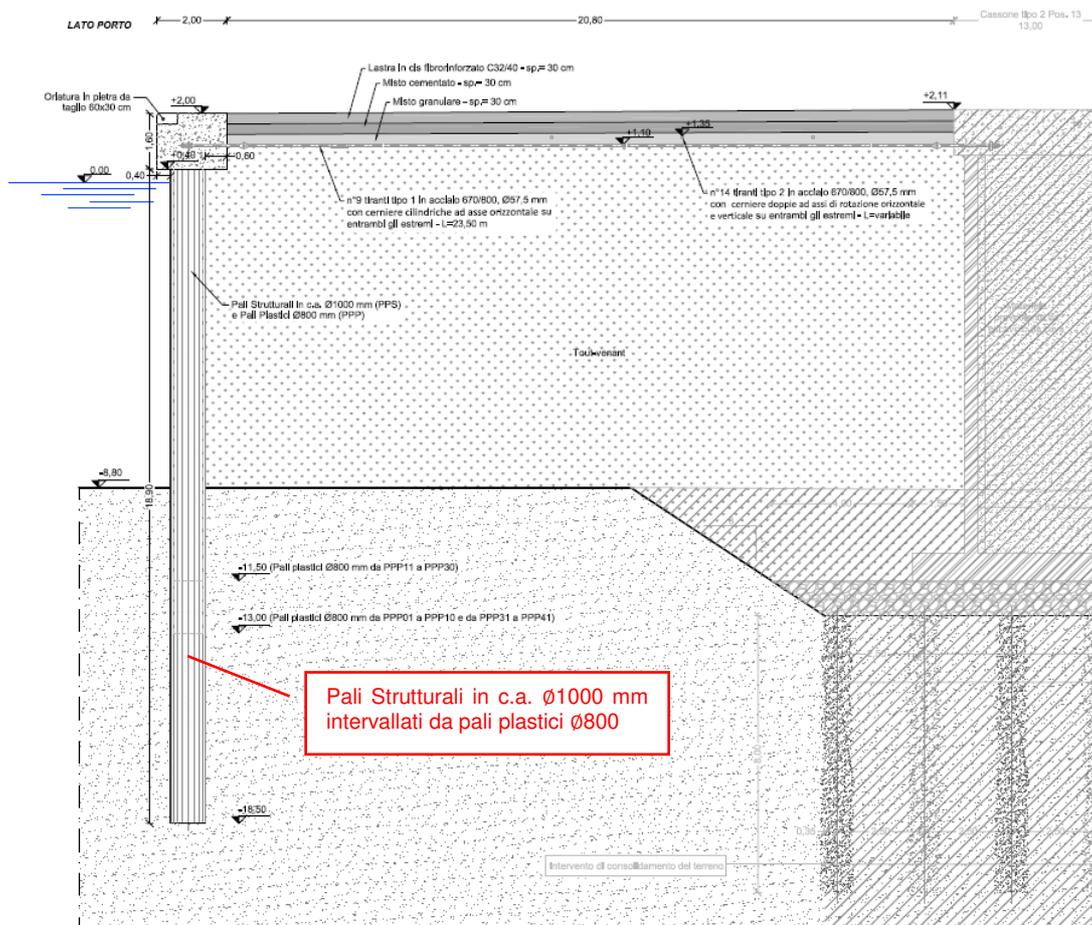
Progetto Esecutivo: Sezione tipo piazzale
